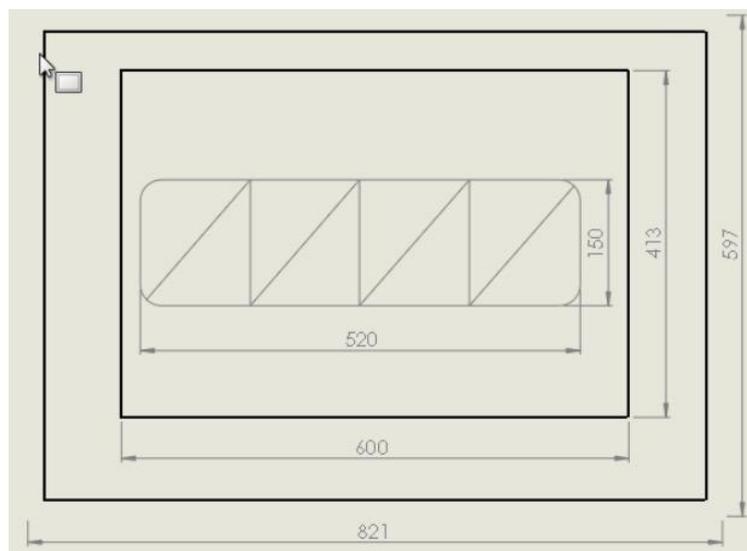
Vista em planta da impressora em um trecho genérico de parede.
